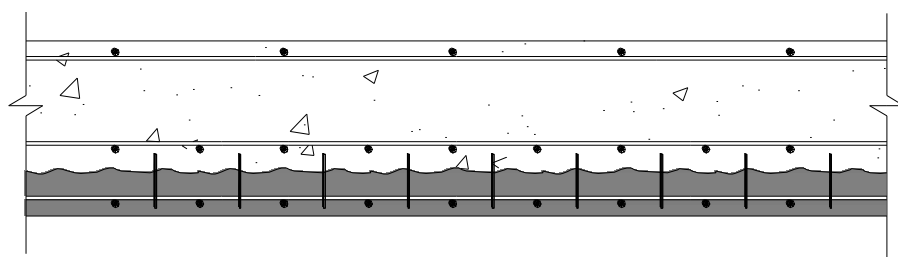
Esquema de reforço de lajes por introdução de novas armaduras com aumento de secção.
